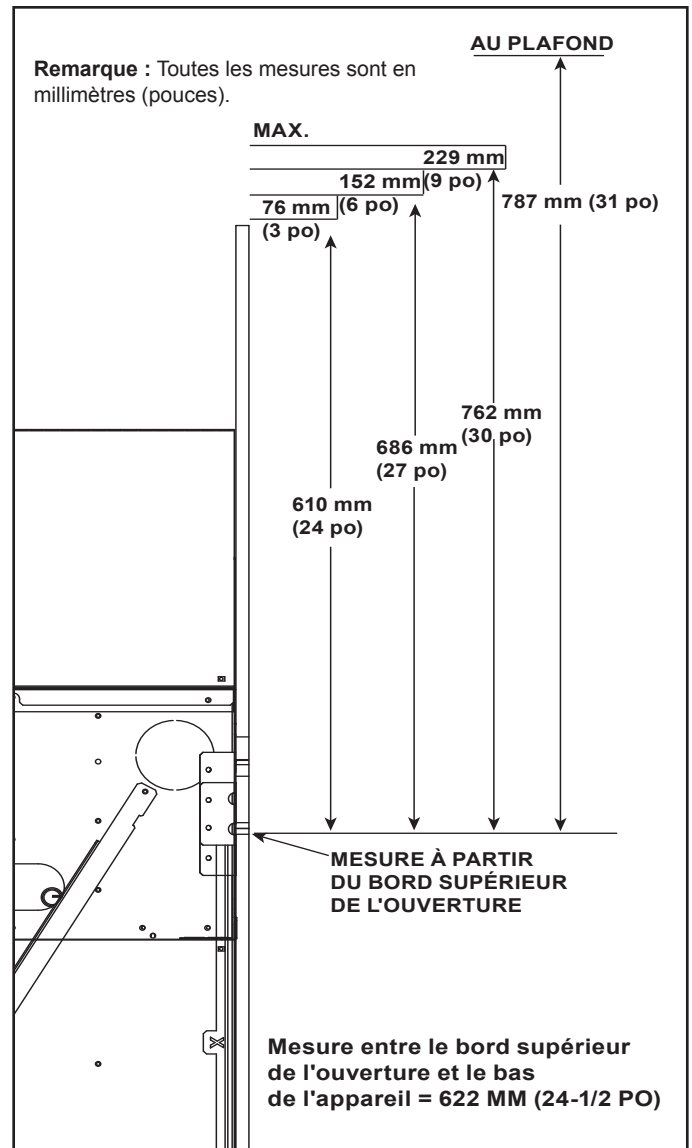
Minimum vertical et maximum horizontal Dimensions par rapport aux matériaux inflammables - CRAVE7260-B and CRAVE8472-B
